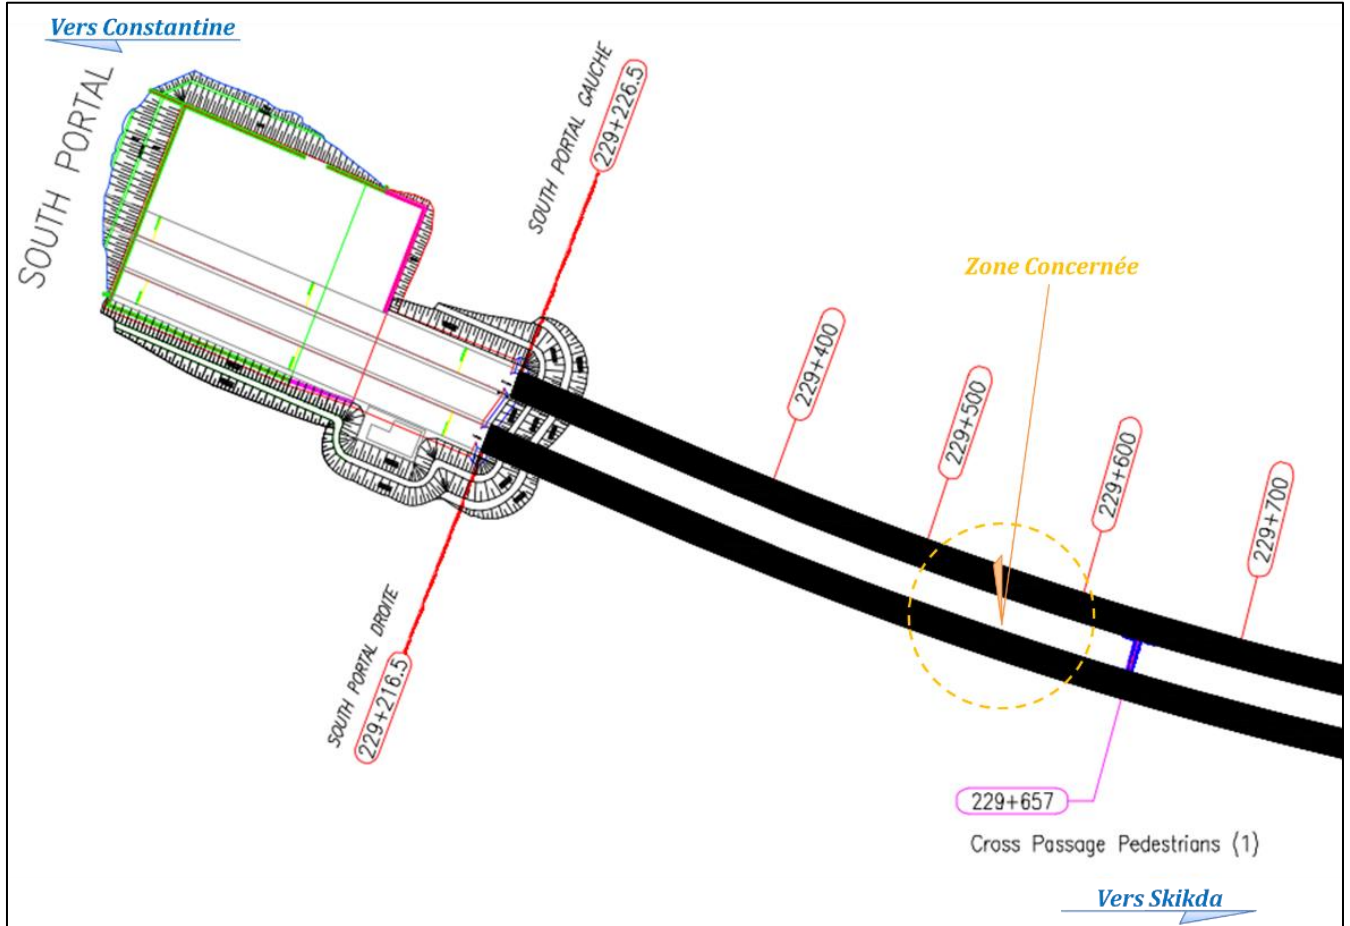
Vue en plan et coupe longitudinale du tunnel T4
